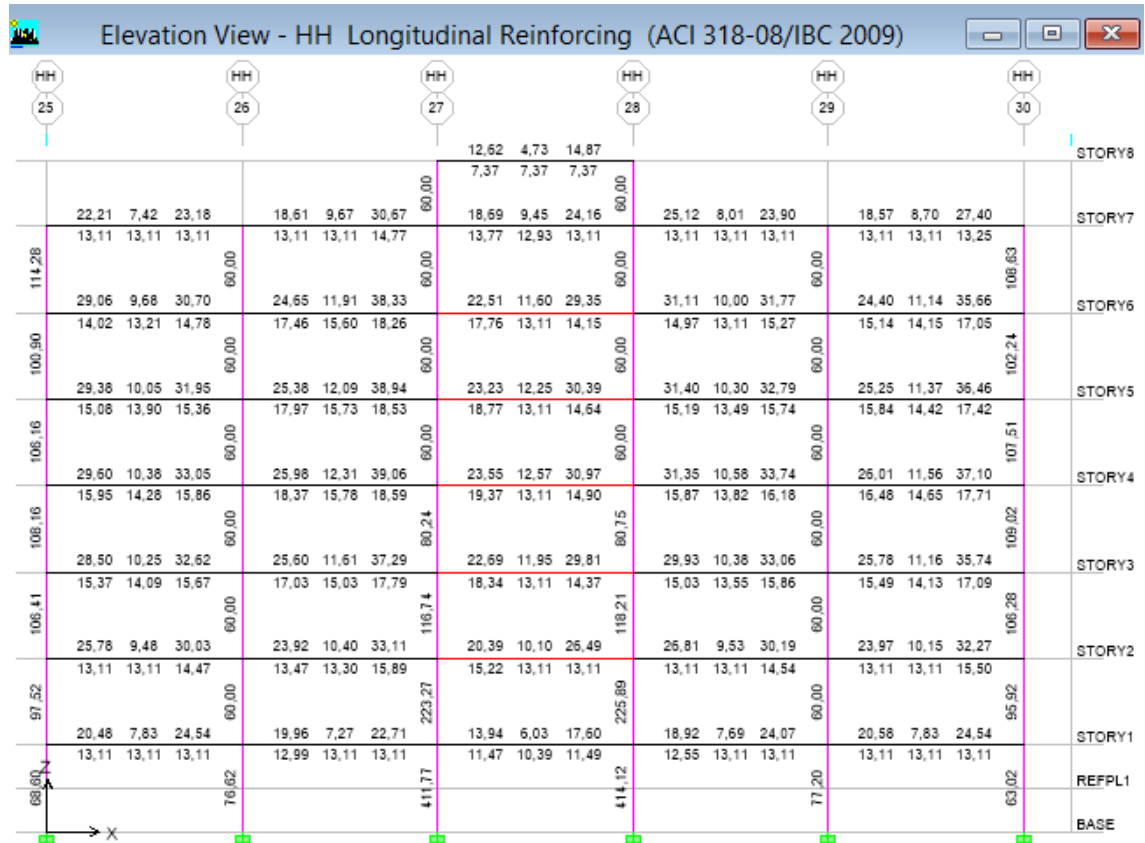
Acero en Vigas y Columnas en el Pórtico HH – Hospitalización 2- (NEC-11)
